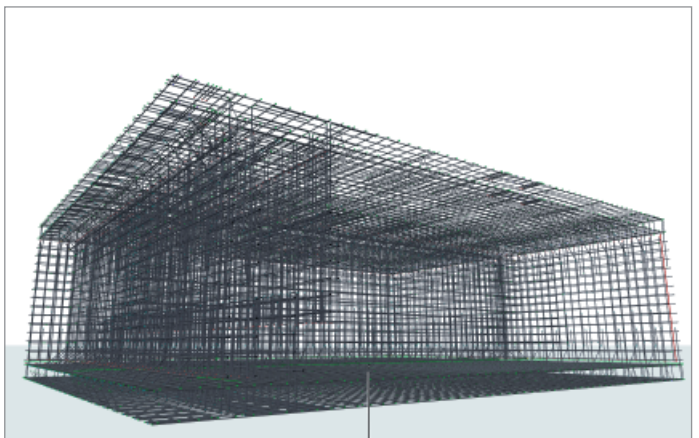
Трехмерный разрез модели резервуара с армированием всех конструкций (бетон скрыт в слоях)
